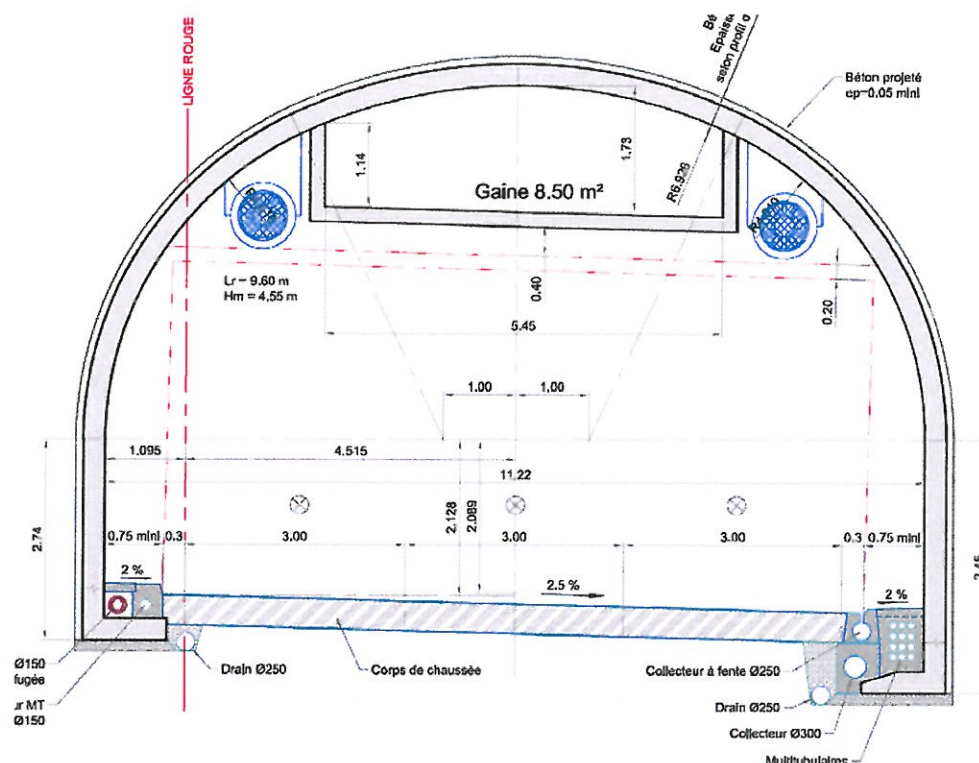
Tunnel de la Duchère : section du tunnel foré avec gaine de ventilation et accélérateurs
